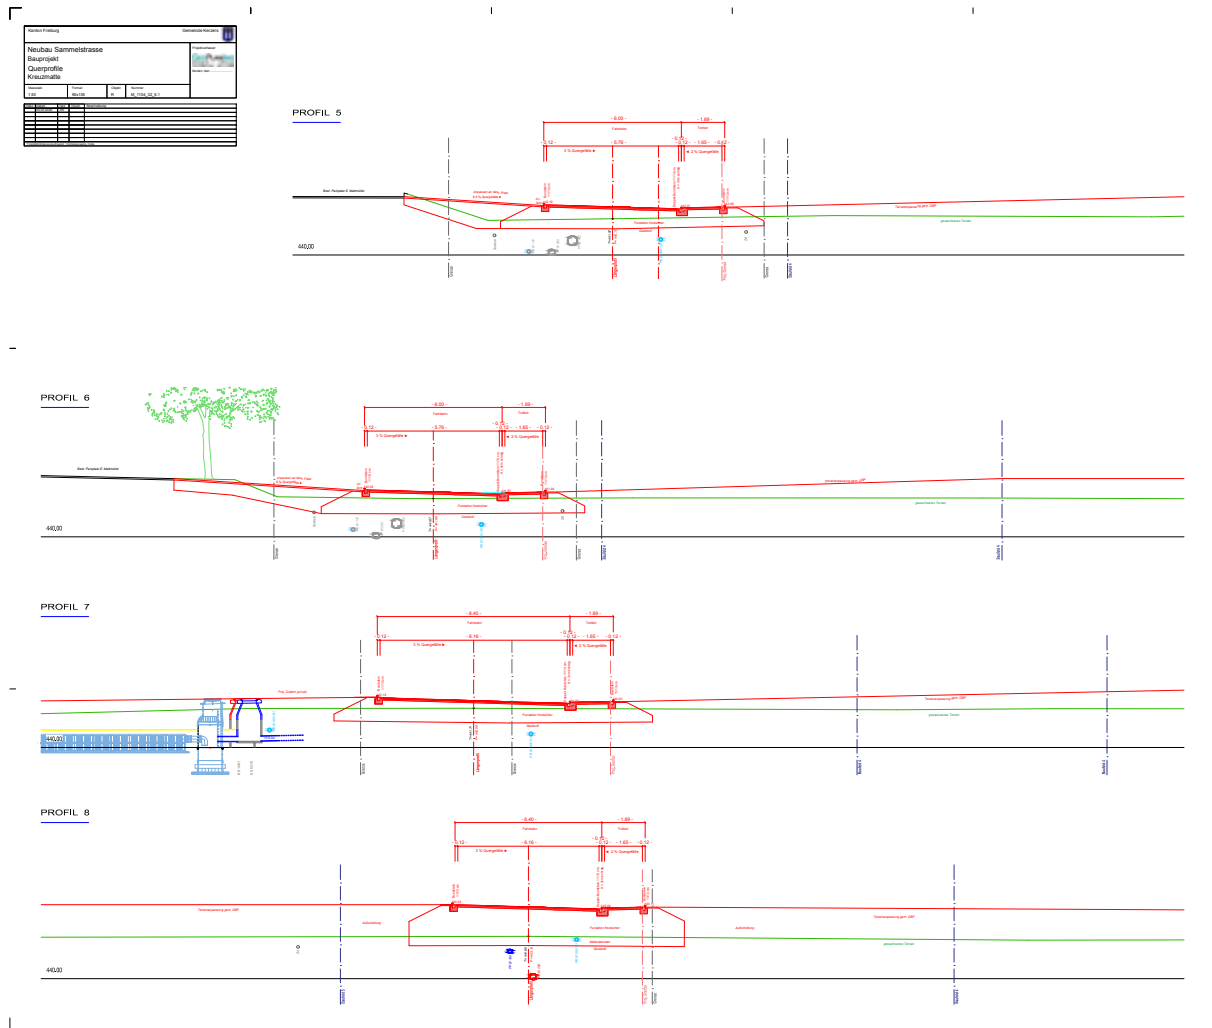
Querprofile 5–8 mit dem Übergang zum bestehenden Mattmüller-Parkplatz. Profil 6 zeigt einen zu erhaltenden Baum auf dem Mattmüller-Niveau. Quelle: GeoPlaning AG, 04.03.2026, Plan-Nr. M_1104_32_6.1.
